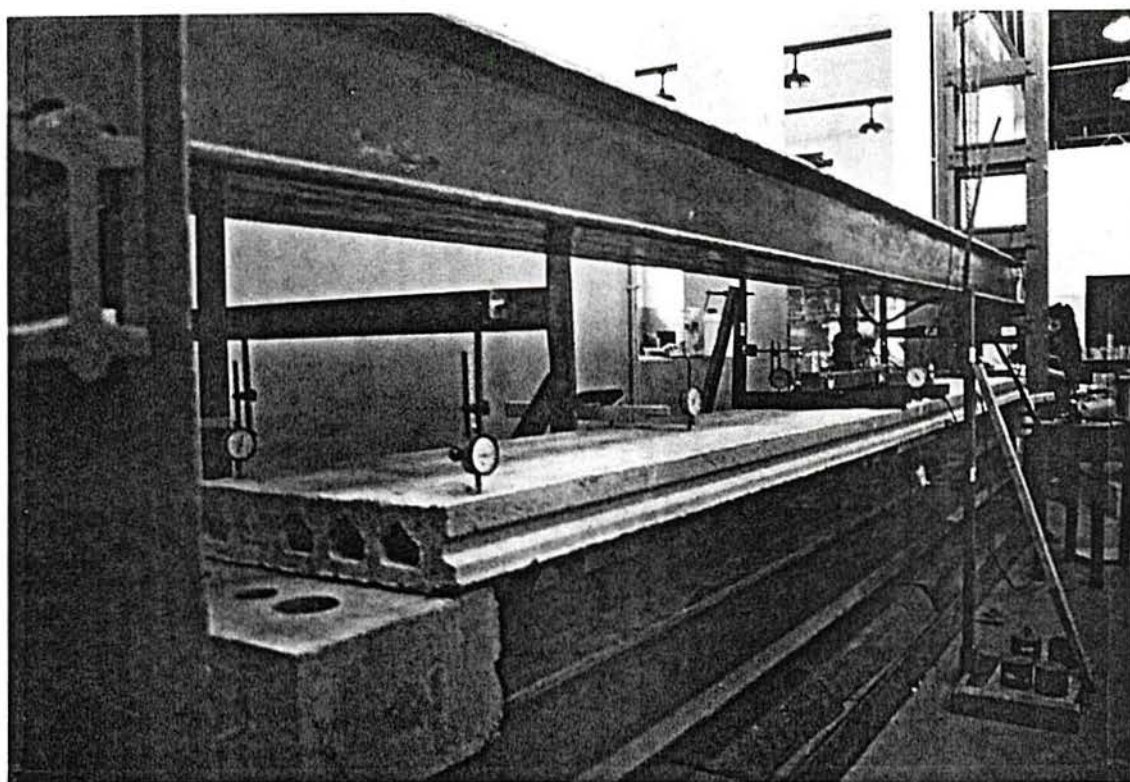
Vista do protótipo B1, anterior ao carregamento
